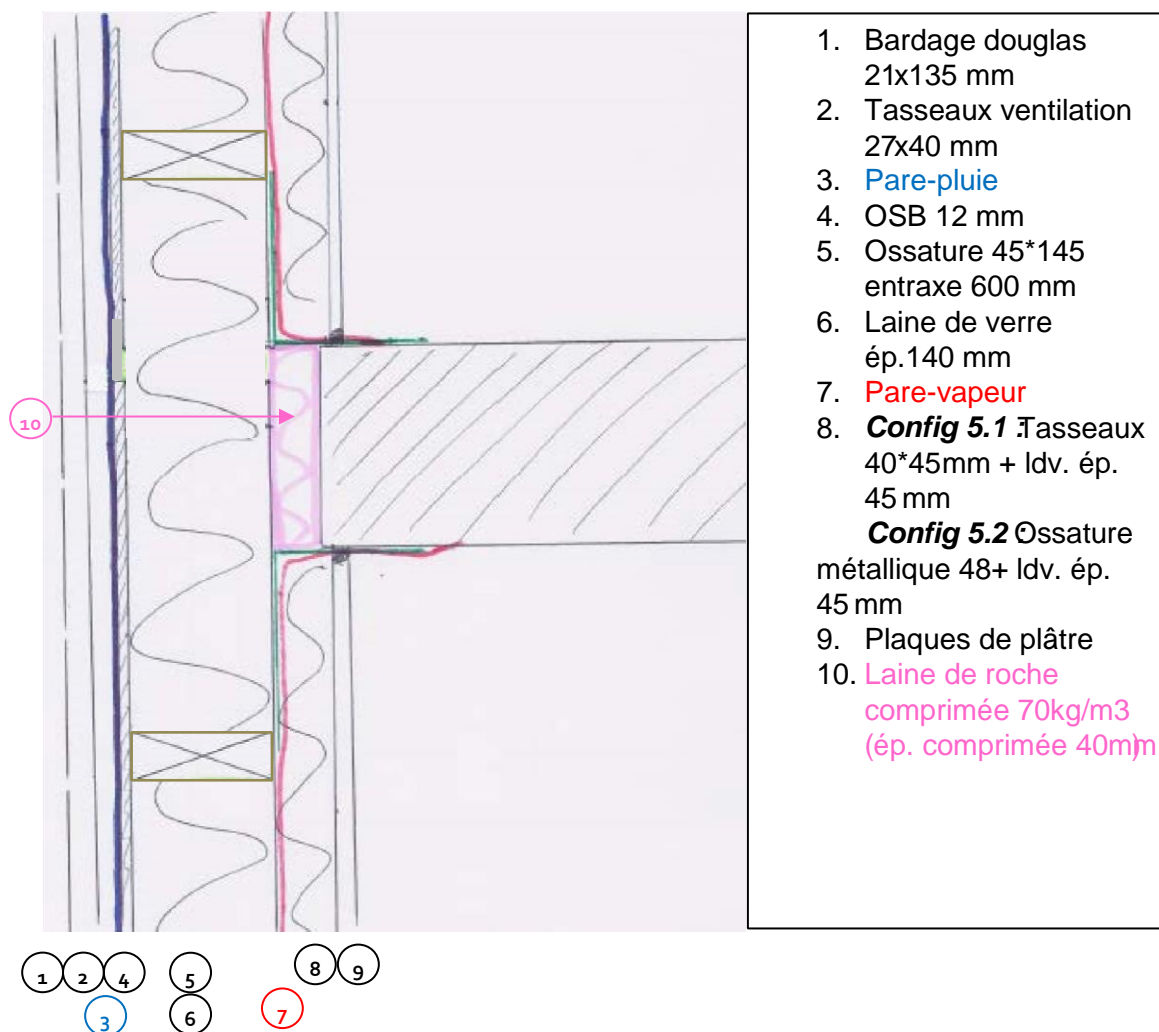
Façade d'un seul tenant avec contreventement extérieur –
